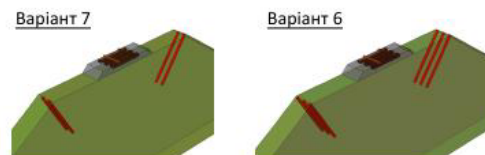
Схема розташування залізобетонних паль укріплення на відкосах земляного полотна в моделі широкого насипу висотою 6 м
